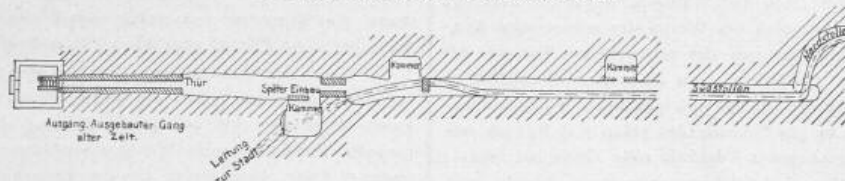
Grundriss des Südstollens der Wasserleitung von Samos.
